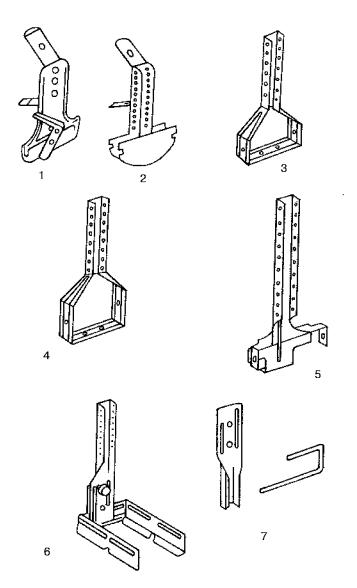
Подвесы для металлического каркаса подвесного потолка: 1 — анкерный фиксатор с блокировкой; 2 — комбинированный подвес; 3, 4 — хомуты; 5 — нониус; 6 — универсальный соединитель; 7 — верхняя часть подвески и шплинт
